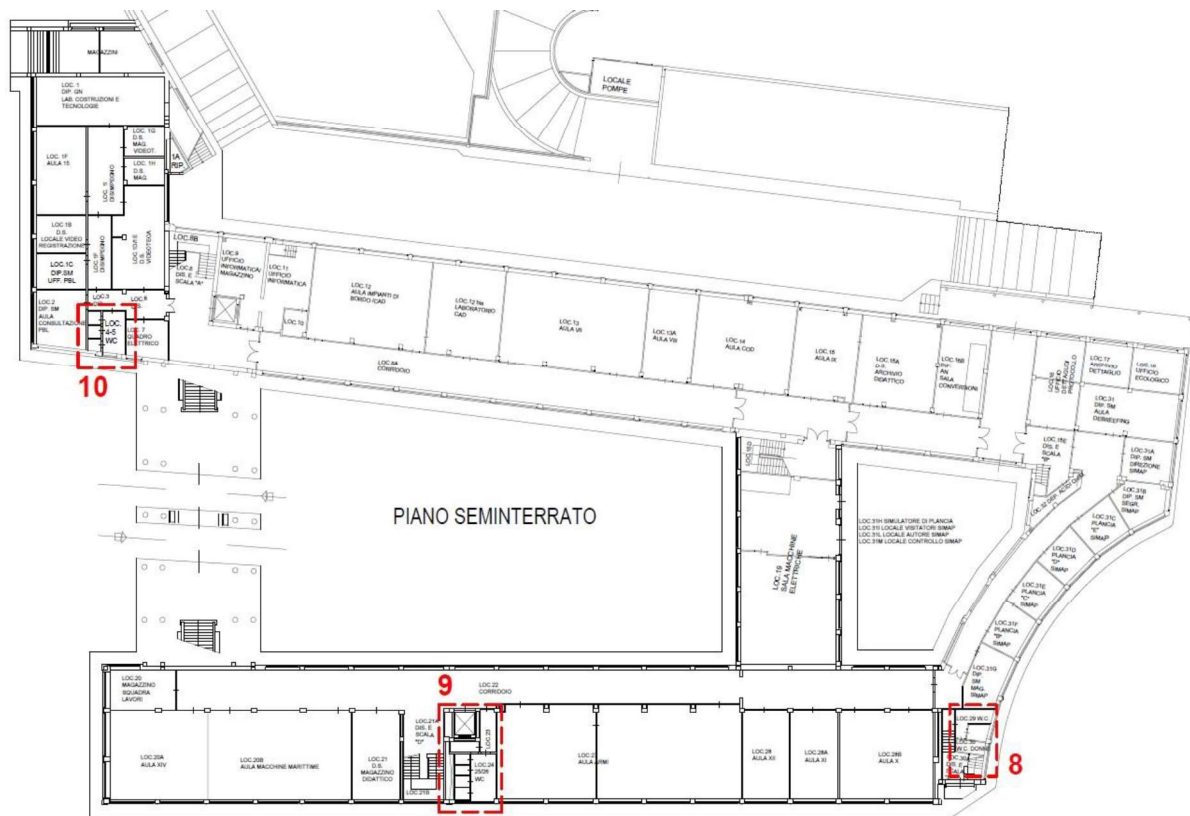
Planimetria piano seminterrato con indicazione dei servizi igienici oggetto di intervento.
